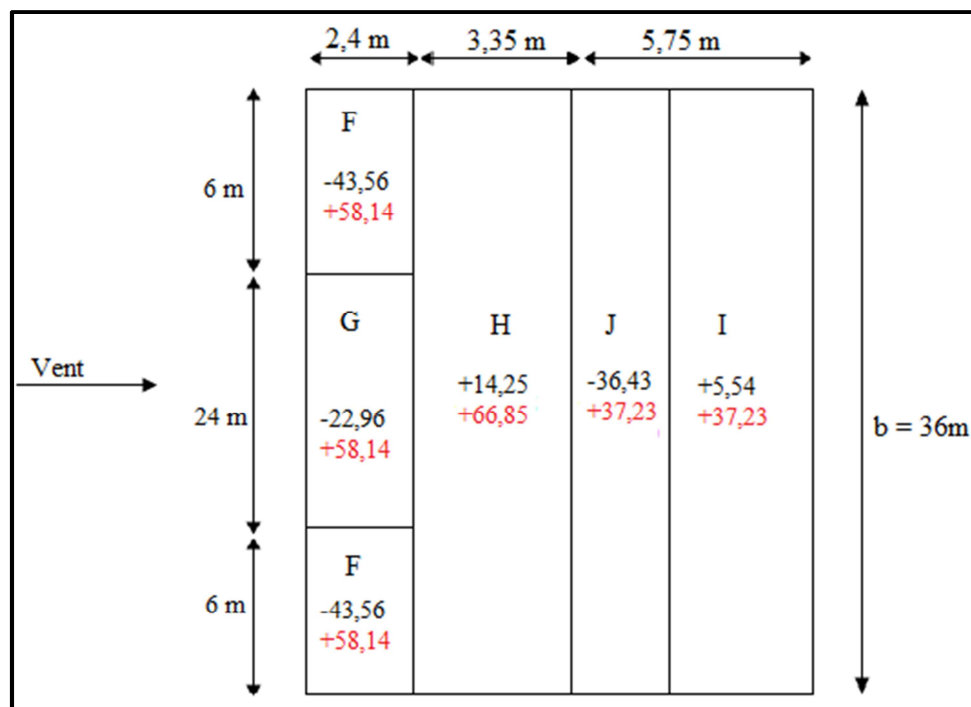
Pressions sur la toiture directions du vent (V2,V4) [daN/m²].
